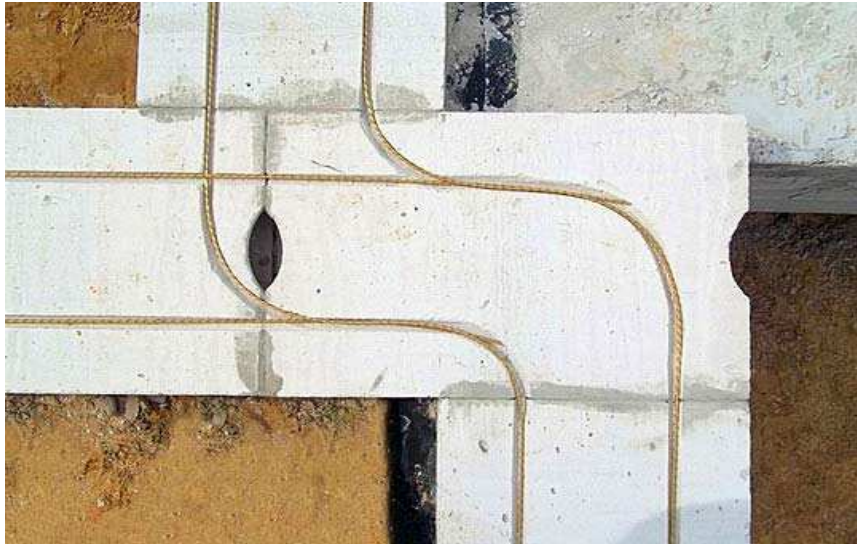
Армування газобетонної кладки композитною арматурою в штробу
